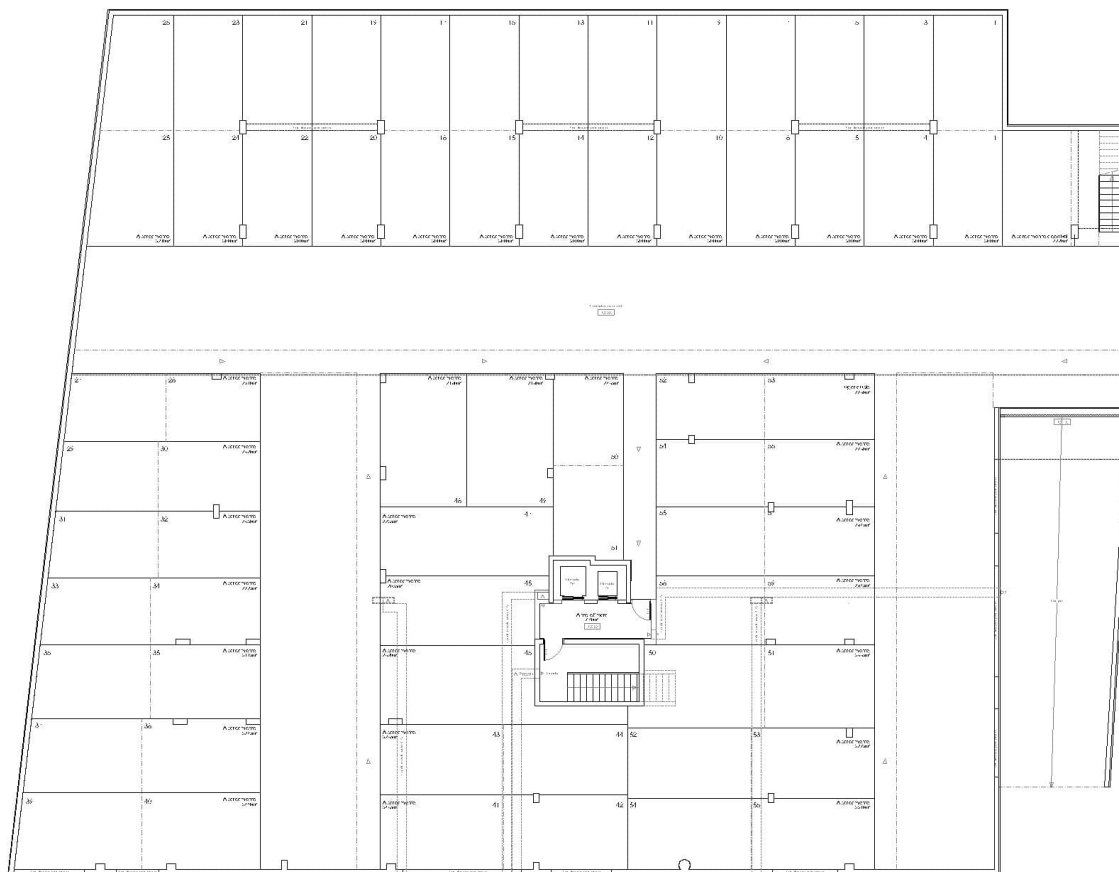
Planta arquitetónica da cave (Projeto de Arquitetura)
